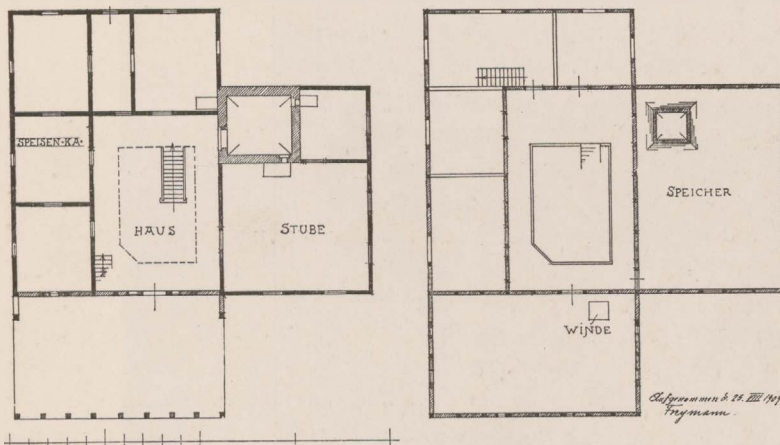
Grundrisse des Wiebeschen Hauses in Neumünsterberg. Maßstab 1:400.
